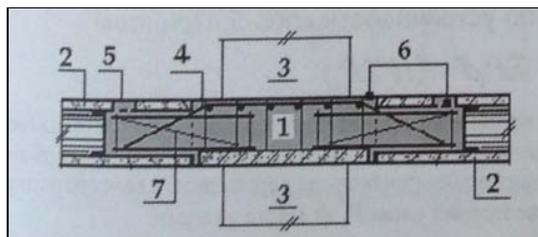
Сечение 1-1 на рис. 2 для варианта сборно-монолитного плитного ригеля, вписанного в толщину перекрытия (со скрытыми опорными консолями)
